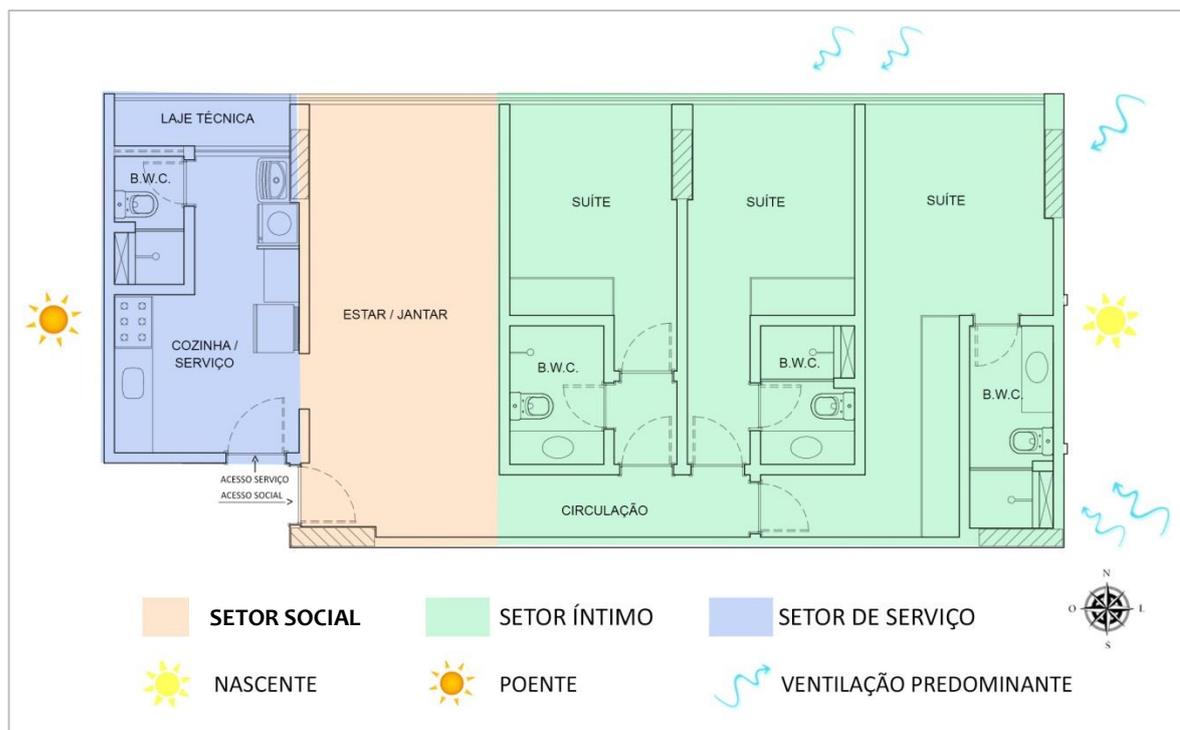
Planta baixa do apartamento tipo das terminações 03 e 04 do edifício Marine Park
